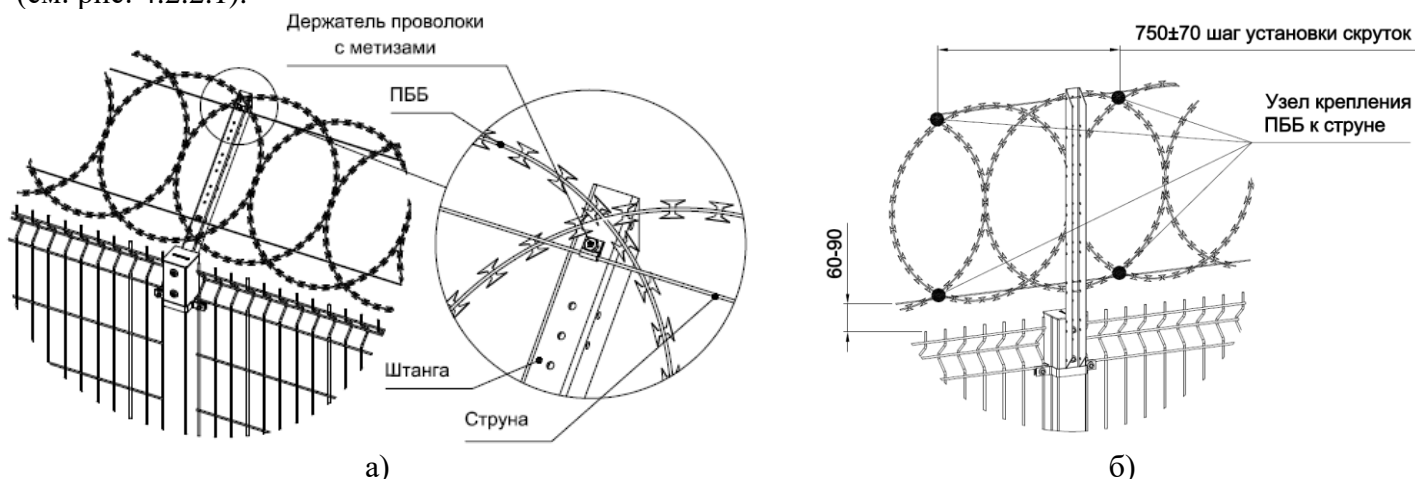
Крепление ПББ (а - к Г-штанге, б – к I-штанге).
